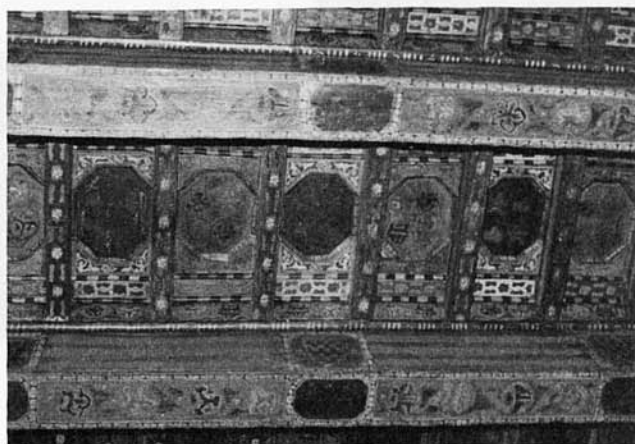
Detalle de la decoración de las jácenas (Fundación B. March).
